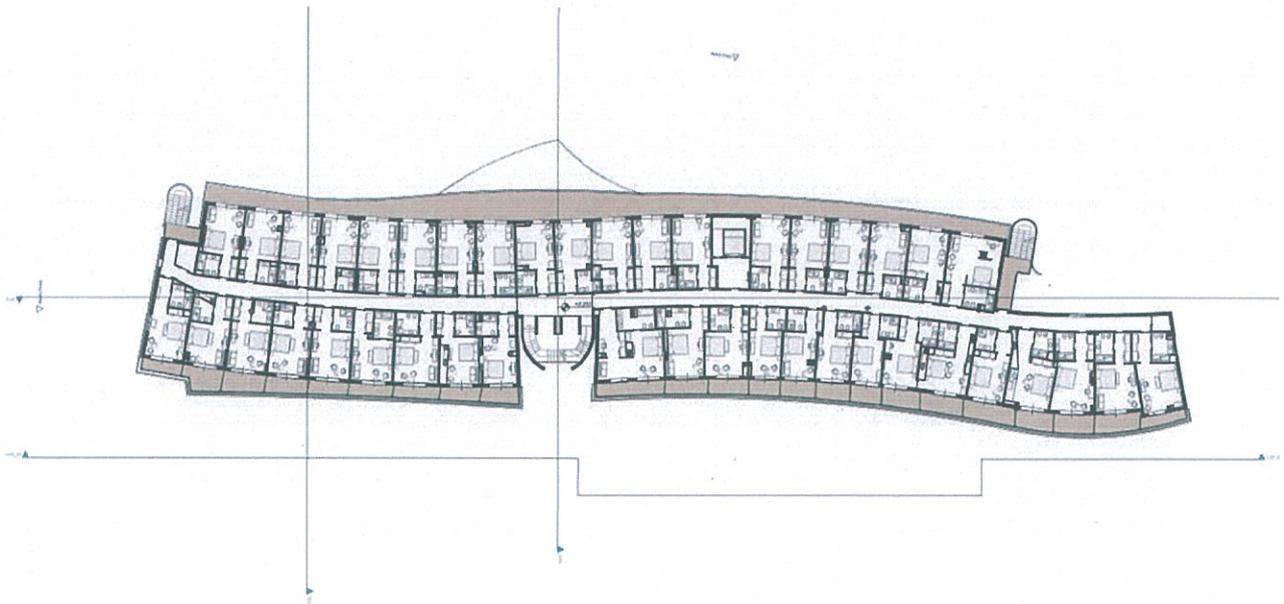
Planimetri e katit të parë Mobilim (kuota +4.80)
